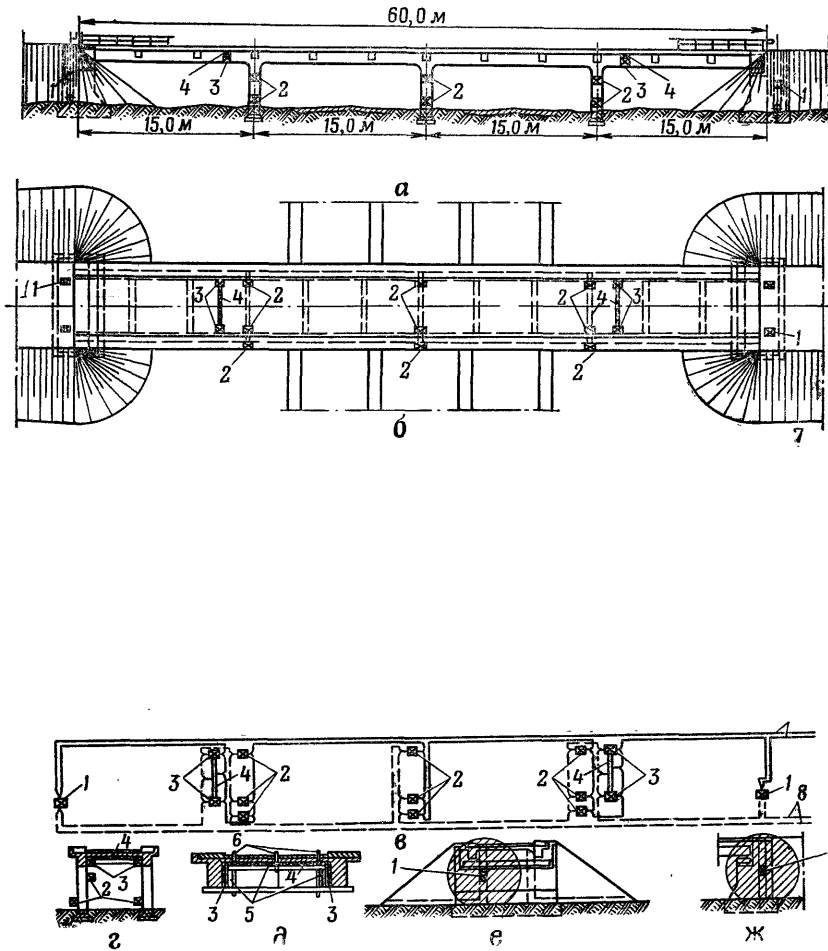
Схемы расположения зарядов и электровзрывных сетей на конструкциях подрываемого железобетонного путепровода:
